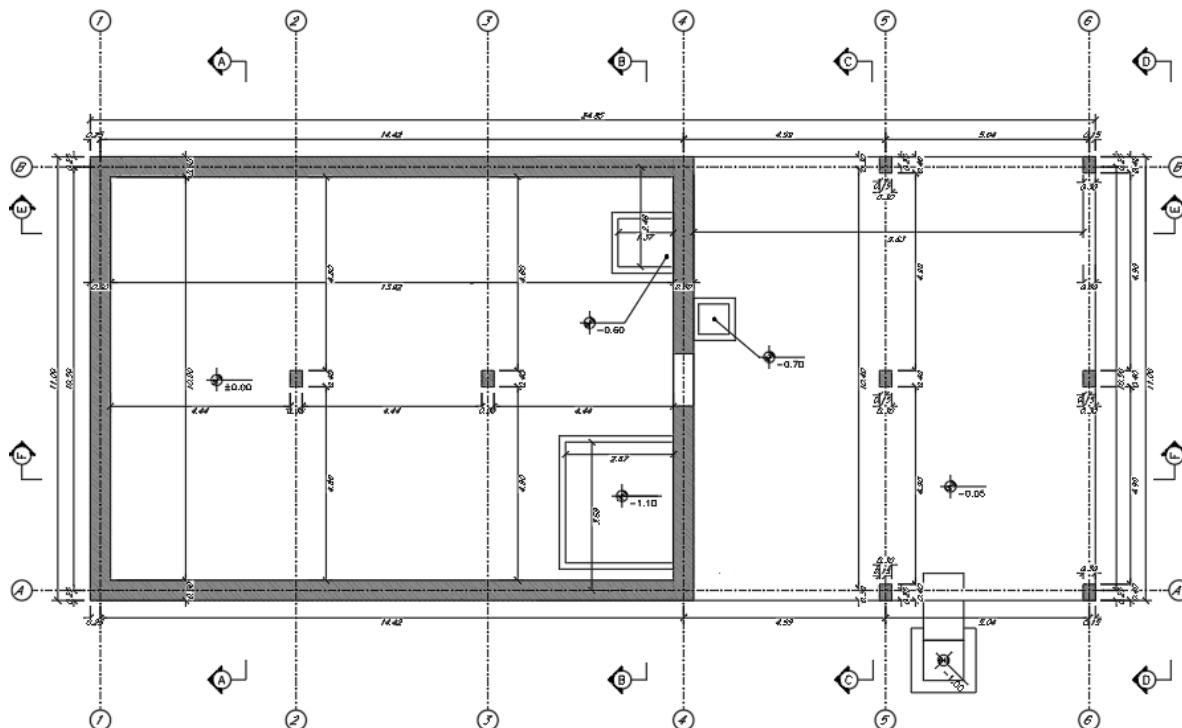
PIANTE PIANO TERRA FABBRICATO FA03
